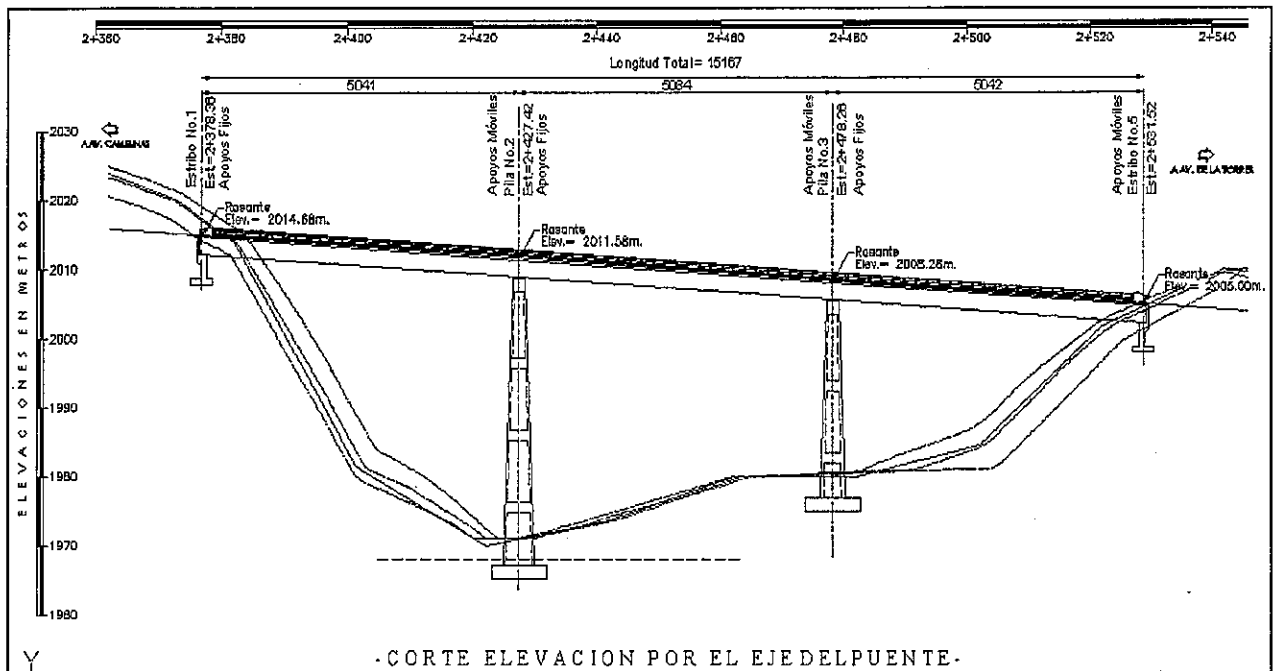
Perfil con la ubicación de los estribos y pilas de la subestructura
